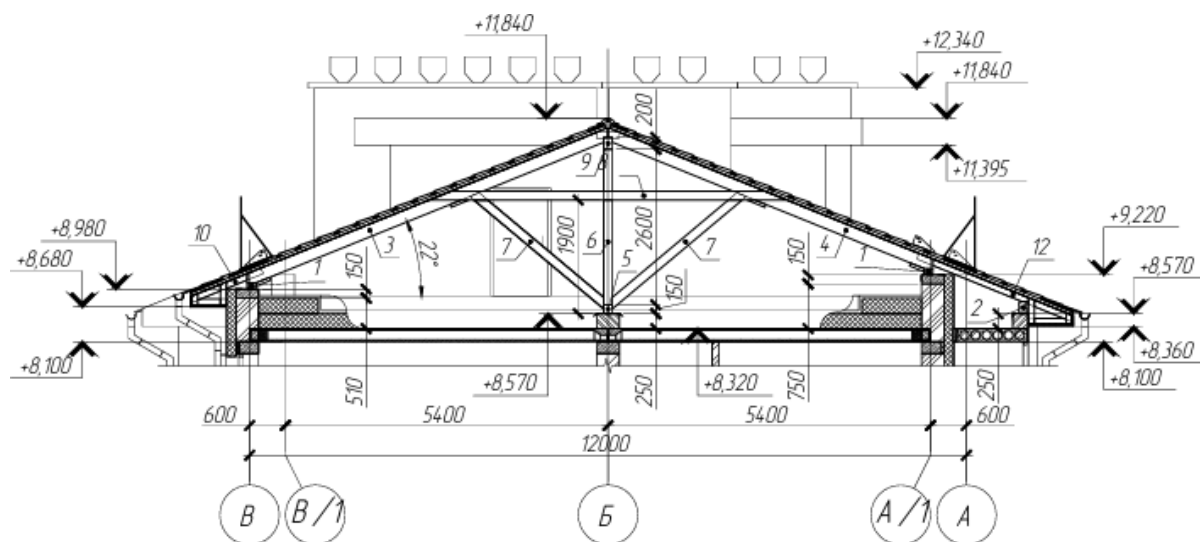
Схема конструктивного решения стропильной конструкции фрагмента покрытия
